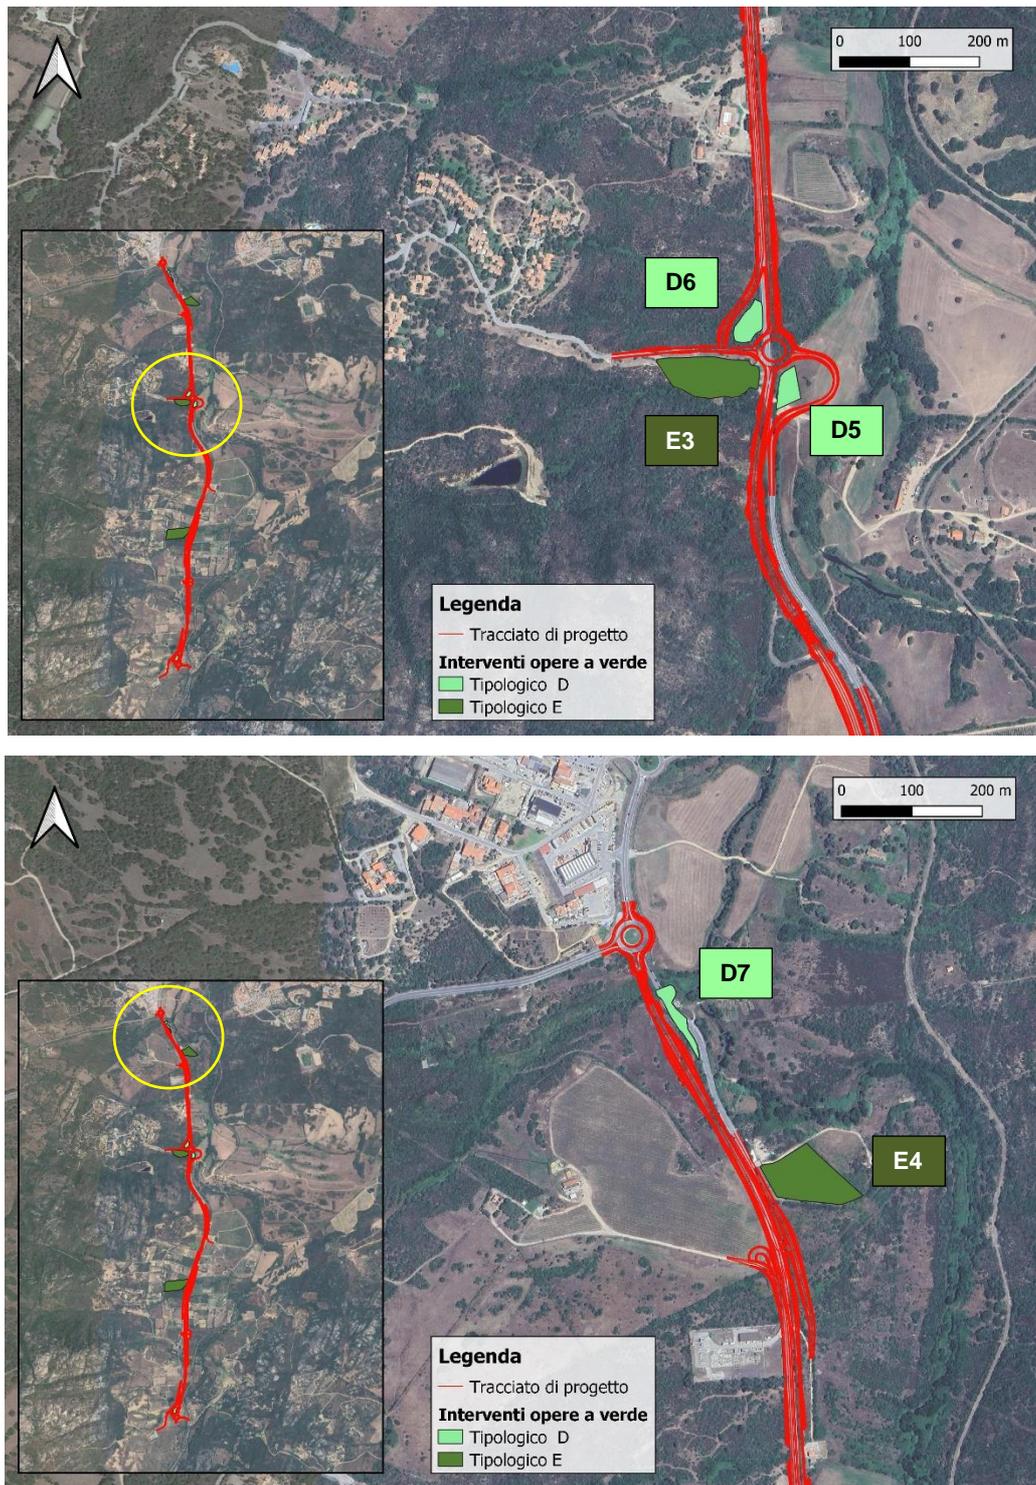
Localizzazione delle aree di reimpianto rispetto al tracciato per la tratta nord
